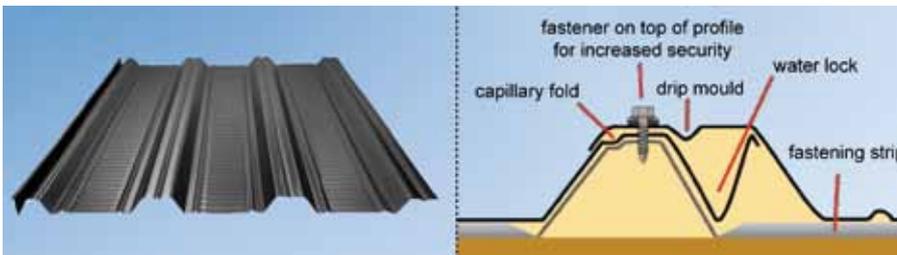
Cerramiento de cubierta Plannja 40 y detalle constructivo (para cubiertas con pendientes entre 3-6°)
